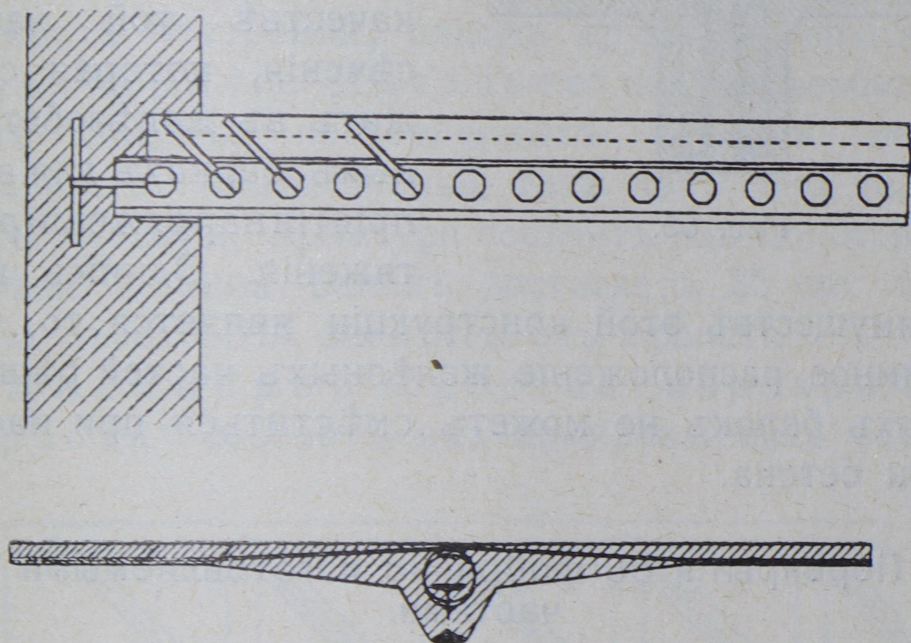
Перекрытіе съ желѣзомъ бульбъ.
